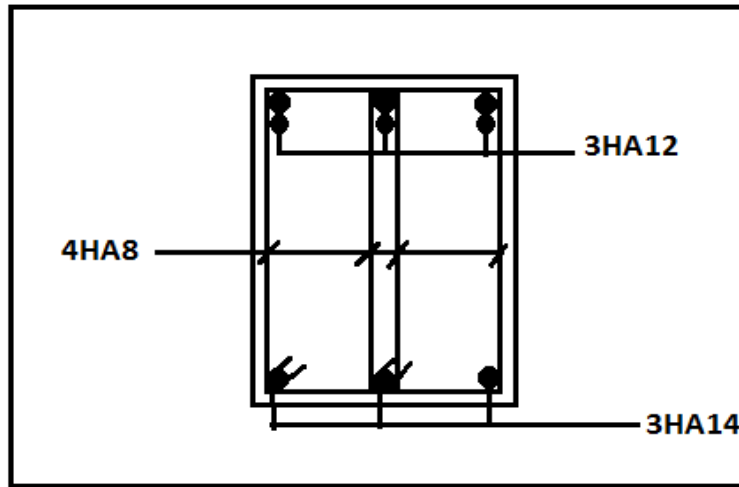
Ferrailage aux appuit d'une poutre principale.
